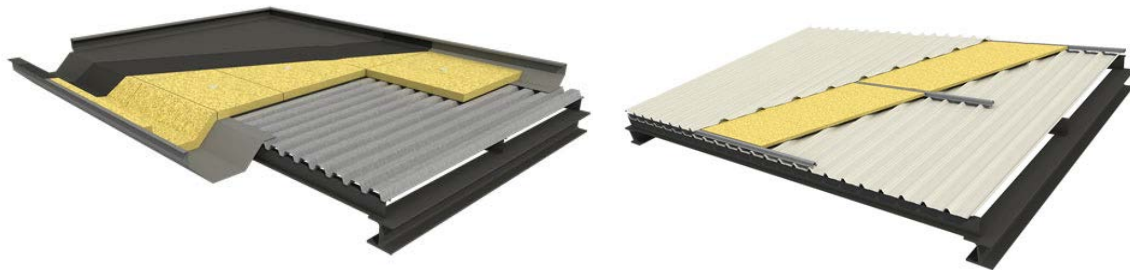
Cubierta tipo deck y cubierta panel sándwich.
